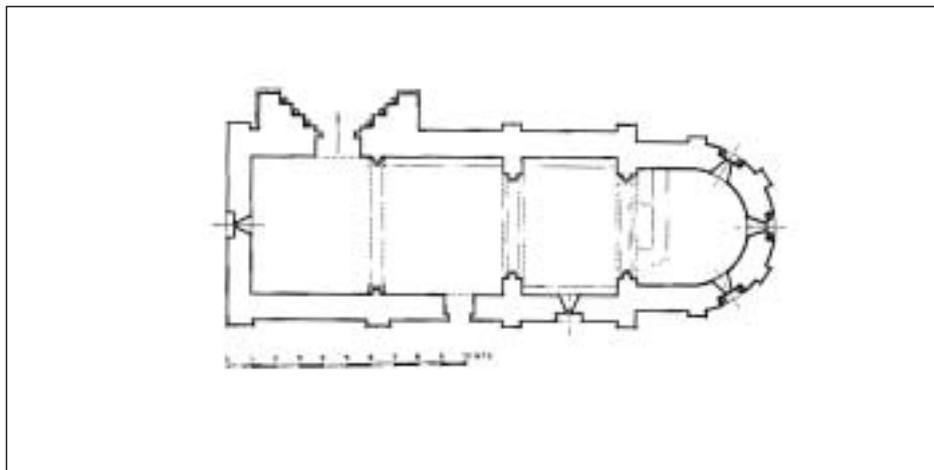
Plano de la planta de la iglesia (Institución Príncipe de Viana)
